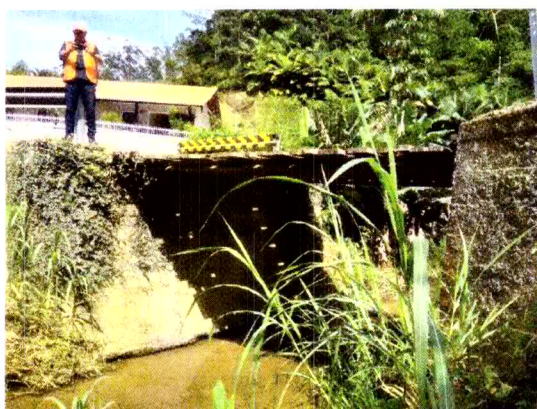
Detalhe da Ponte e Cabeceiras em concreto
